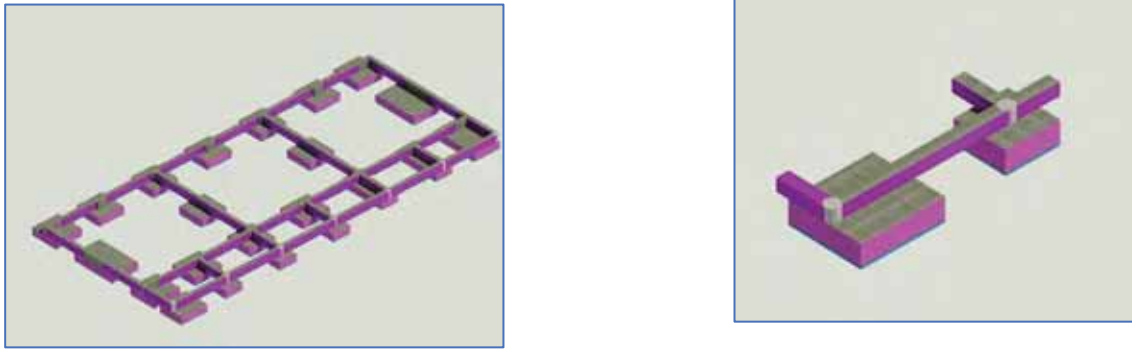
Vista de modelo BIM de zapatas, solados y vigas de conexión
